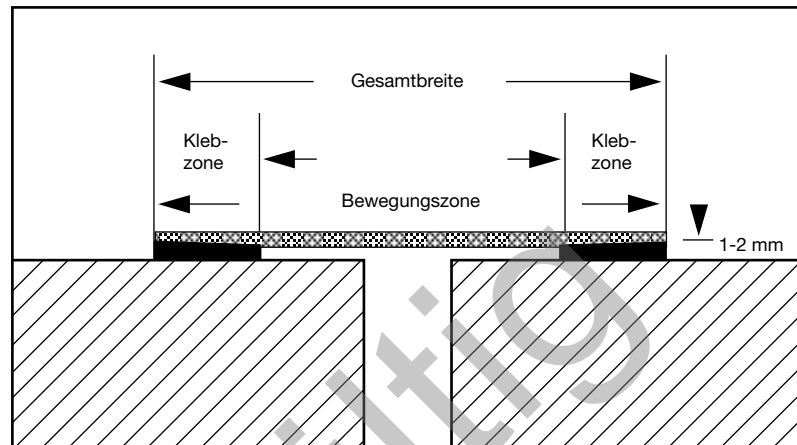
Grundprinzip einer Fugenabdichtung mit Elastomer-Fugenband
